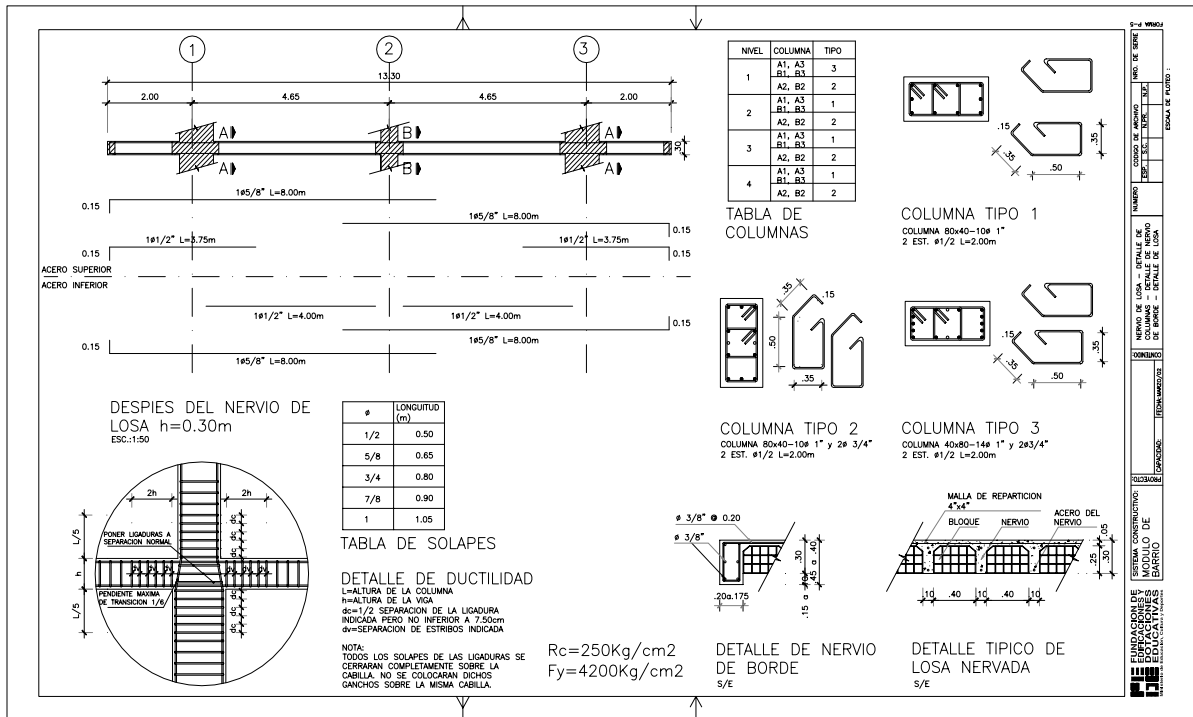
Nervio de losa/Detalle de columnas-nervio de borde-losa. Modulo de Barrio.
